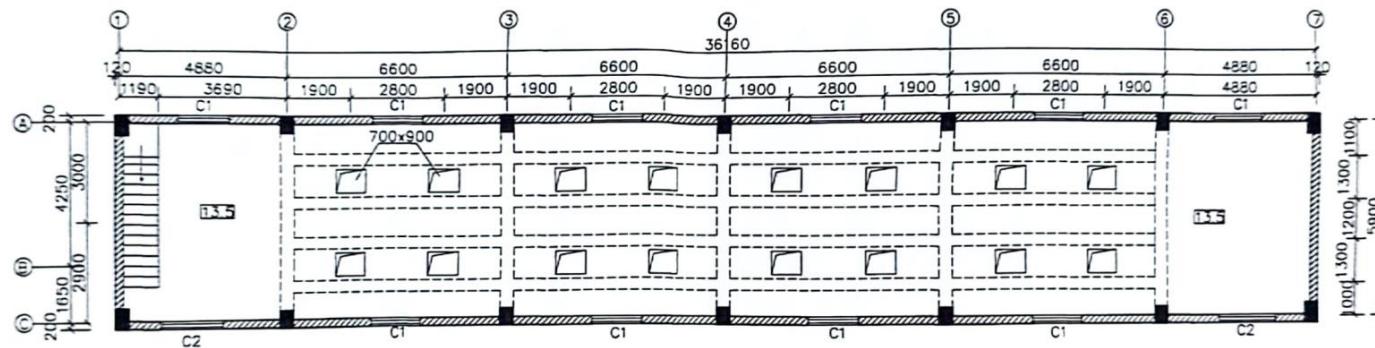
海堤桥闸段分层平面图（高程 6.7m）
